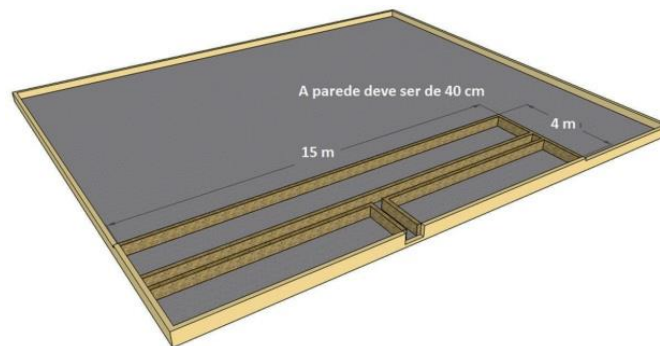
Detalhes das paredes laterais e dos canais de distribuição.
